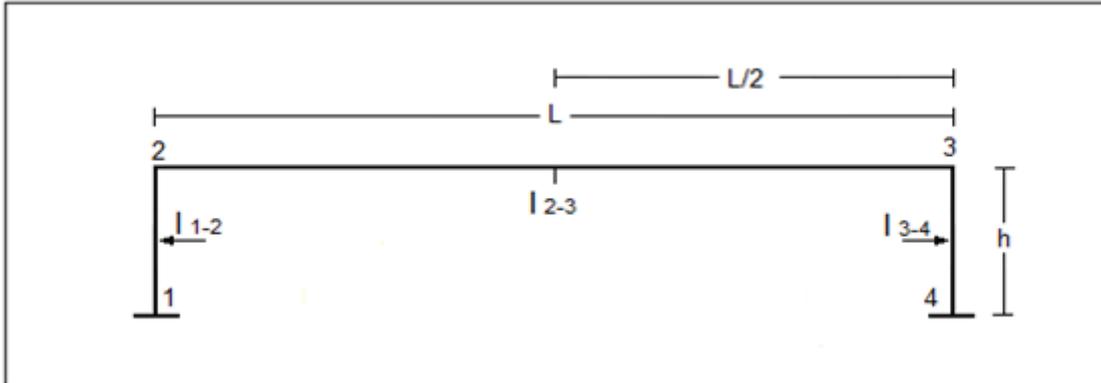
Estructura simétrica en pórtico de soporte fijo.
